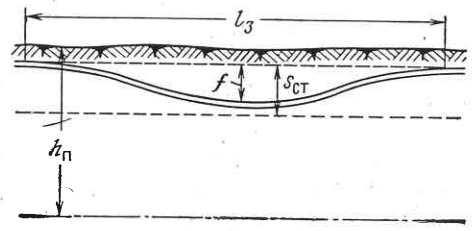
Перемещение трубопровода при оттаивании грунта
